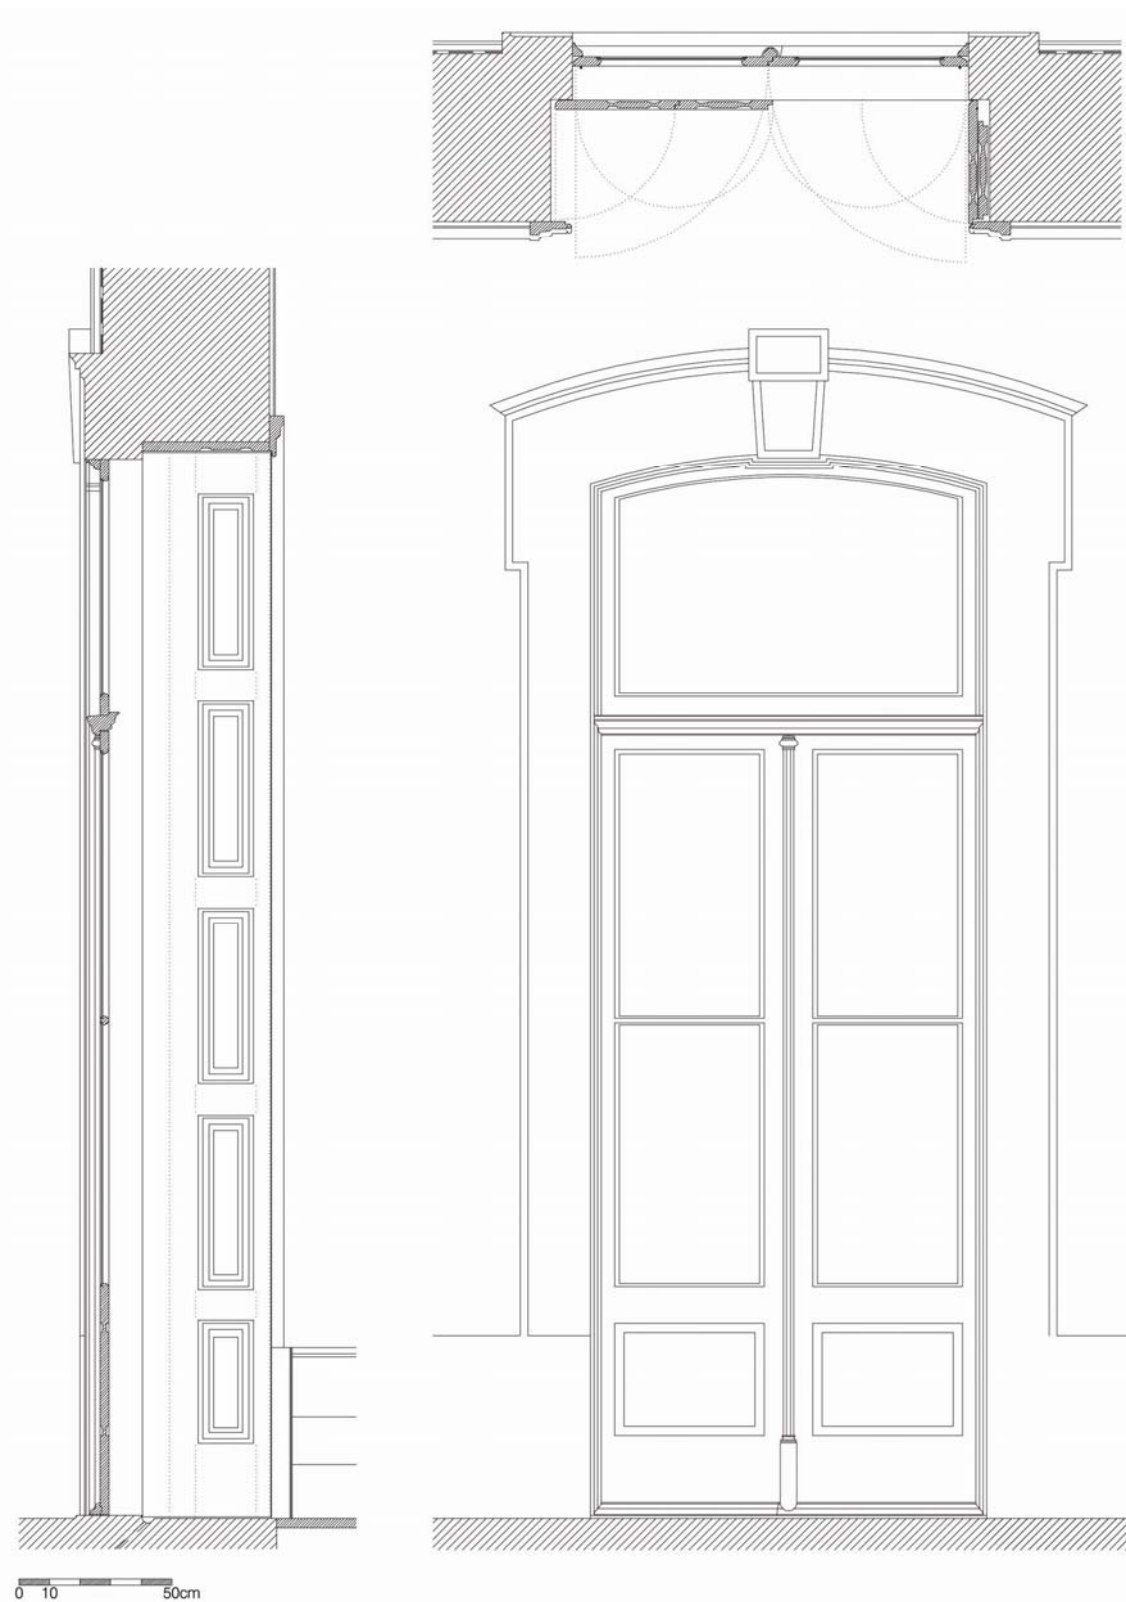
Janela de sacada e batente (duas folhas e bandeira fixa) - corte vertical, corte horizontal e alçado exterior.
